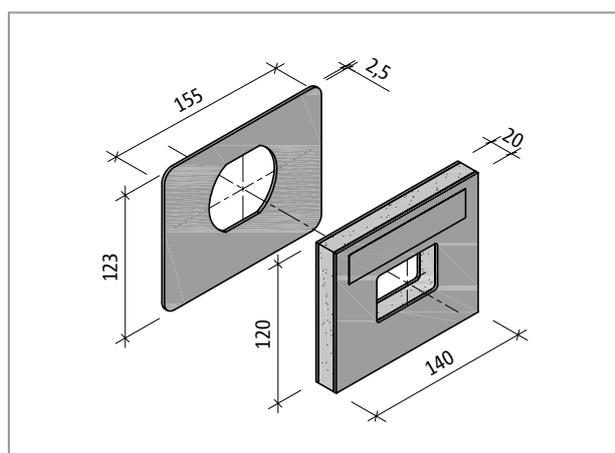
Schöck Tronsole® Typ Q: Brandschutz-Set bestehend aus Brandschutzabdeckung ($t = 2,5$ mm) und Brandschutzmanschette(n)
